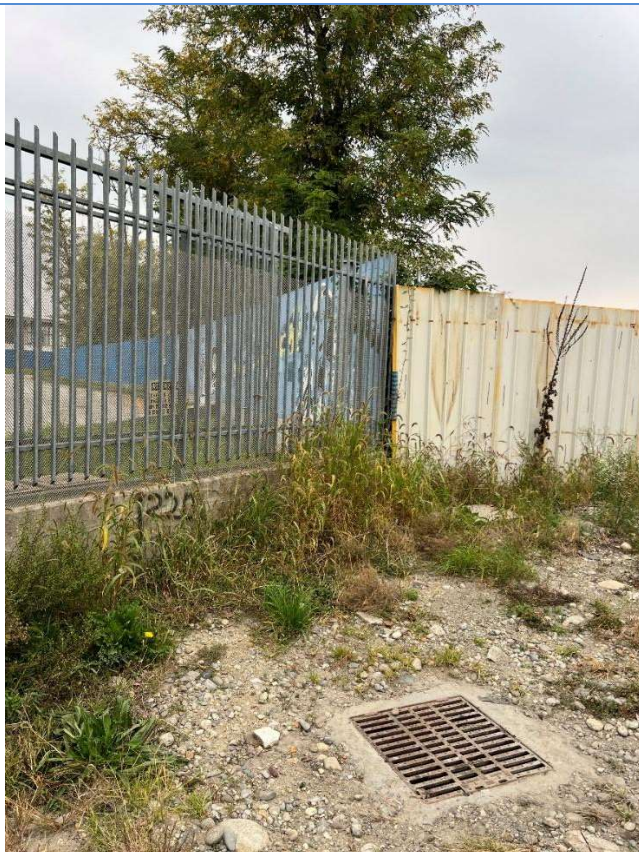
caditoia-ispezione sull'attraversamento di via Rugacesio
